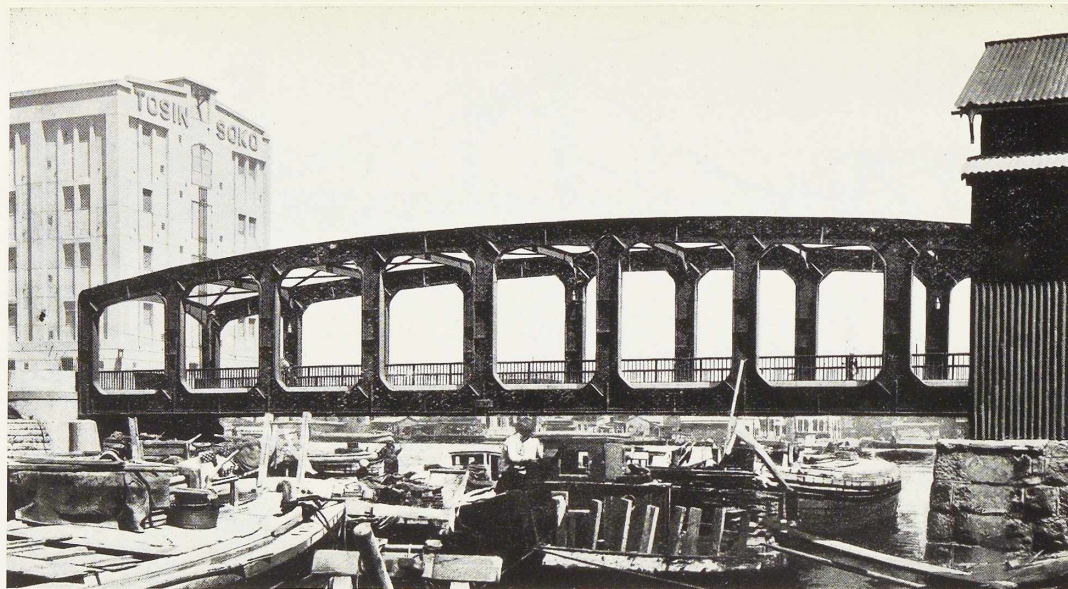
Vue du pont de Toyoumi à Tokyo.
